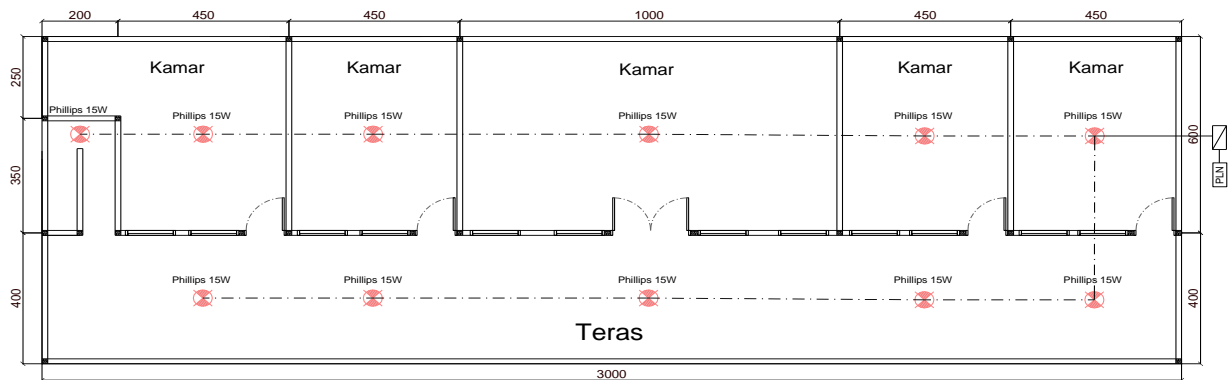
Denah Instalasi Kantor wilayah Zaid Bin Tsabit.
